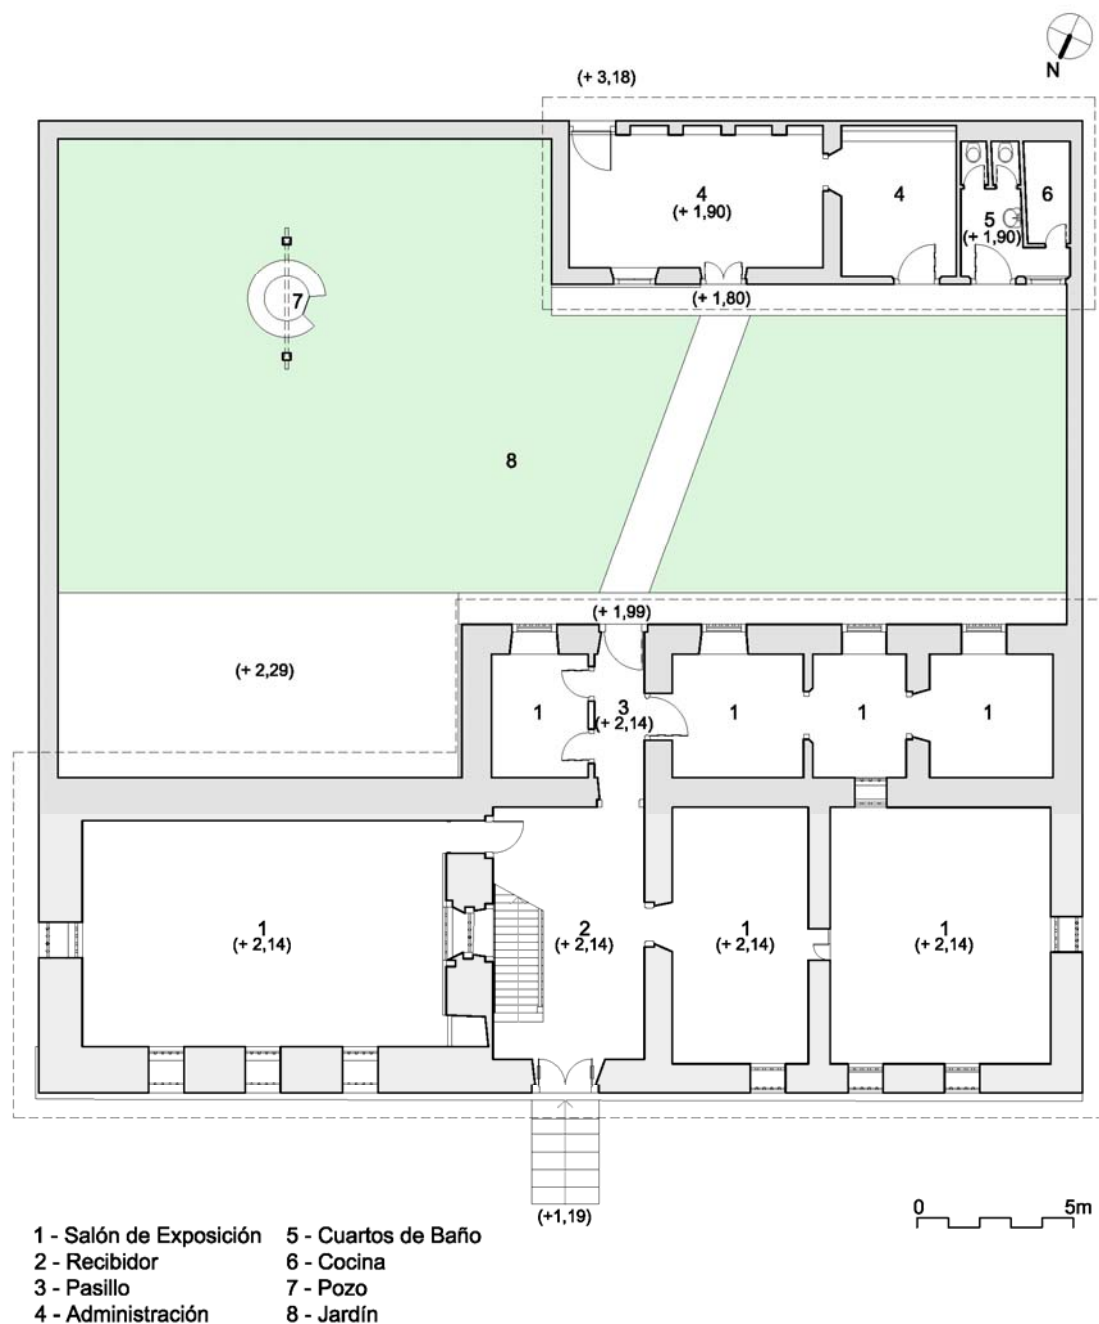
Planta Baja actual del Ayuntamiento y Cárcel de Vila Boa de Goiás, Goiás.
